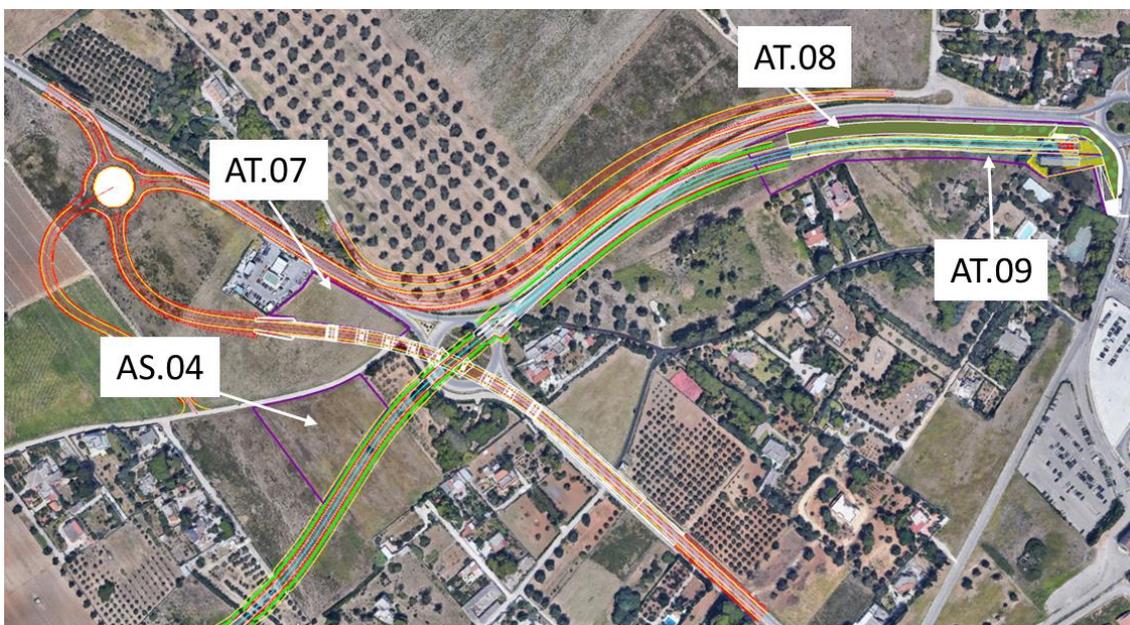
Localizzazione delle aree di cantiere e attività di lavorazione
